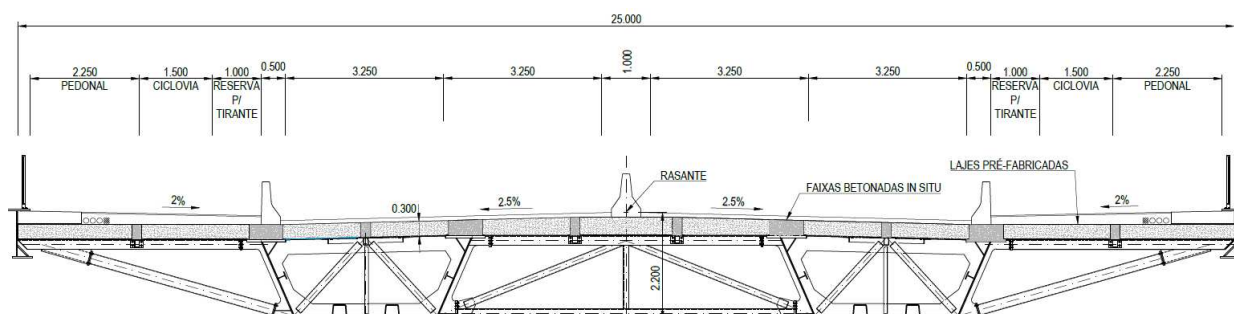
Secção transversal do tabuleiro inferior na zona de atravessamento do Rio Douro
